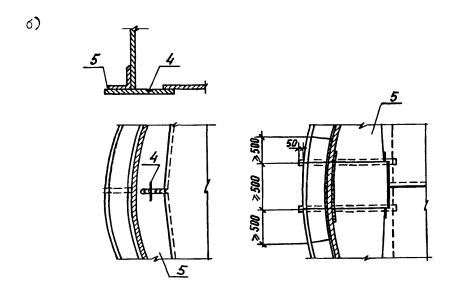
Ремонт днища стального резервуара при трещинах в сварных швах
